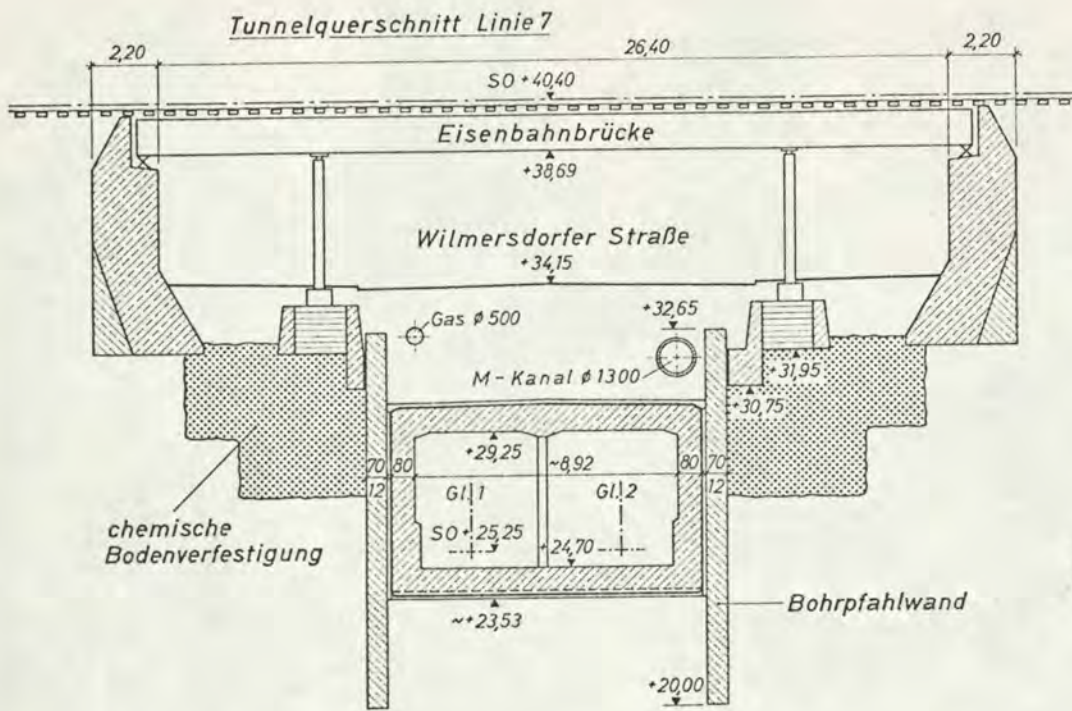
Tunnelquerschnitt unter den Stadtbahnbrücken. (Dargestellt ist die Brücke unter den S-Bahngleisen.)
